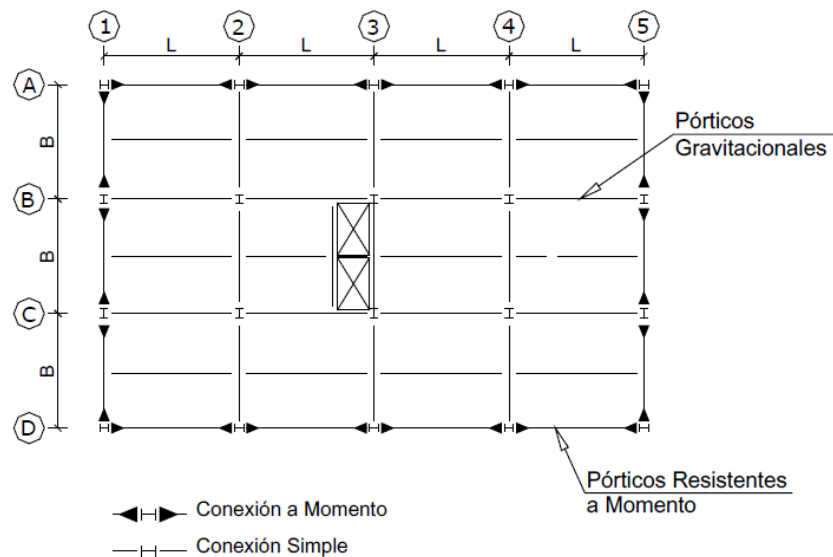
Planta de edificio de Acero Estructural Compuesto por Pórticos Resistentes a Momento y Gravitacionales, FUENTE: NEC-SE-AS
